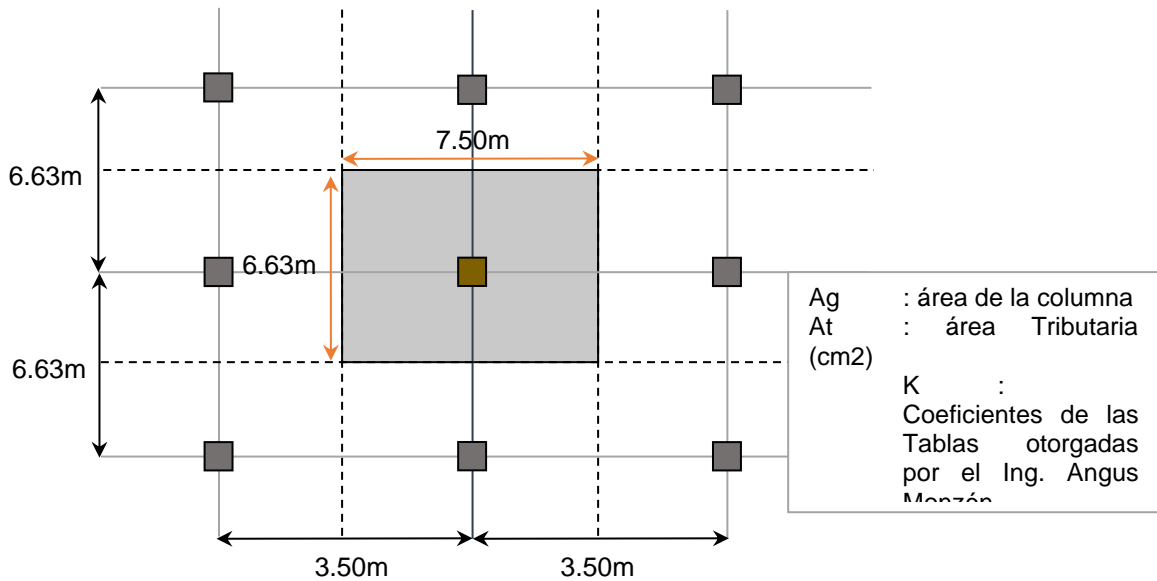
Trama Estructural Proyecto (Bloque Coliseo) Fuente: Elaboración Propia.
